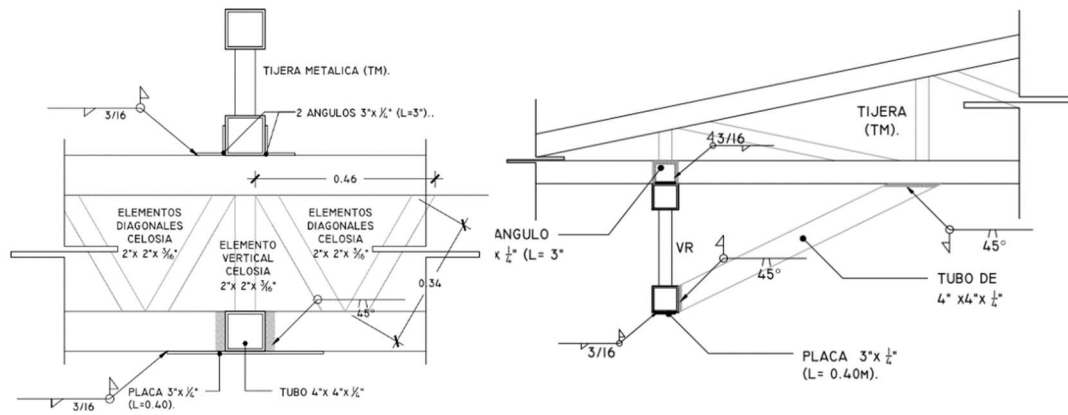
Detalles de Apoyo de Tijera metálica con viga de rigidez. Fuente: Elaboración Propia.
